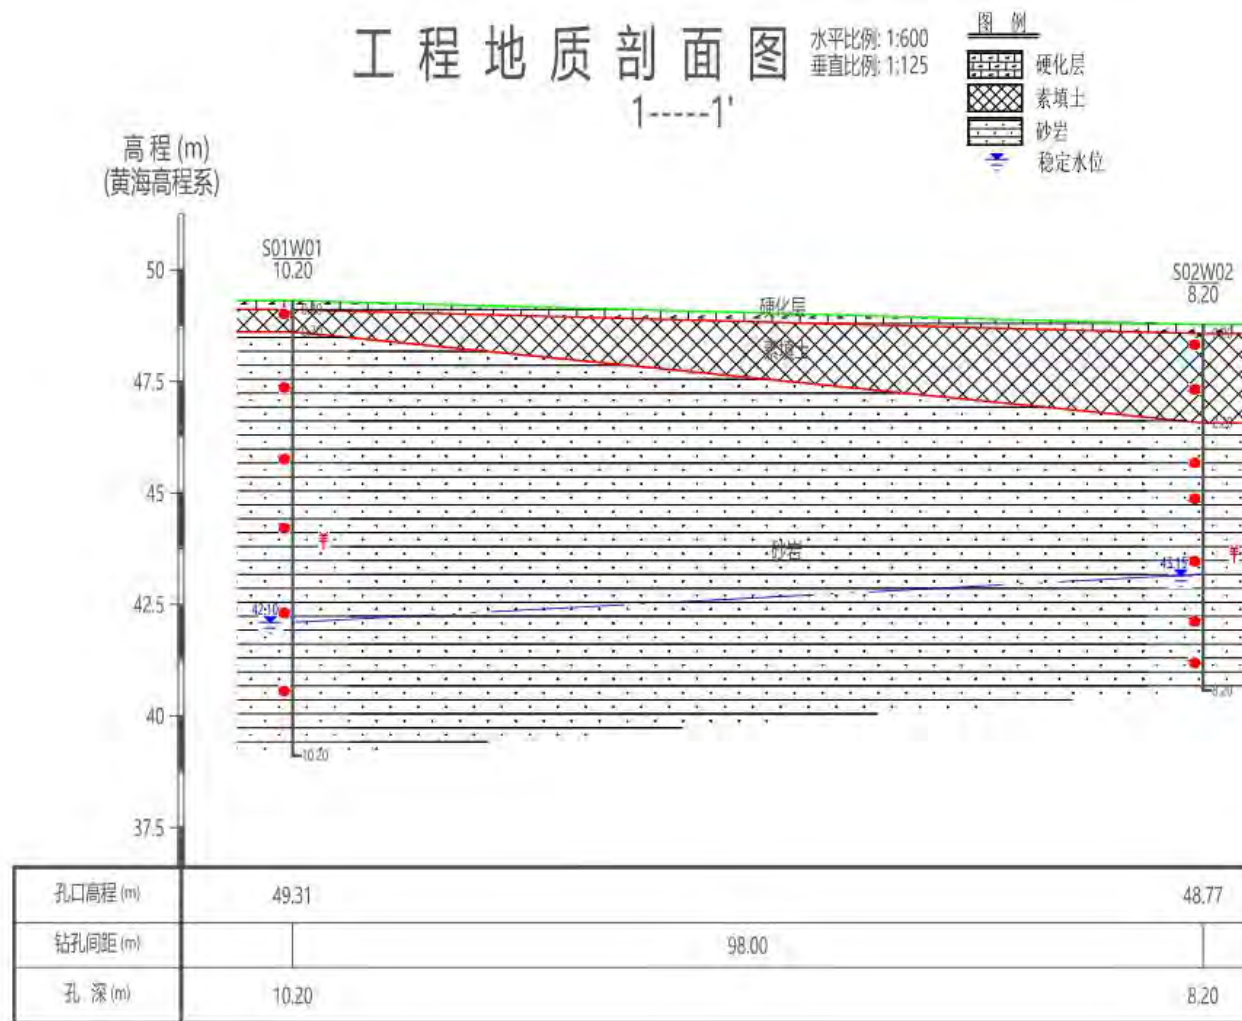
水文地质剖面图 (S01W01-S02W02 剖面)
